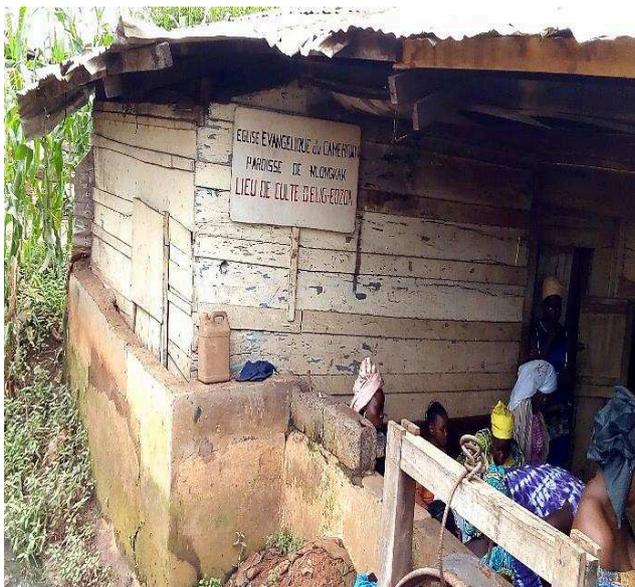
Vue des assises d'une maison précédemment construite en planches de bois renforcées par des parpaings de ciment à Elig-Edzoa
